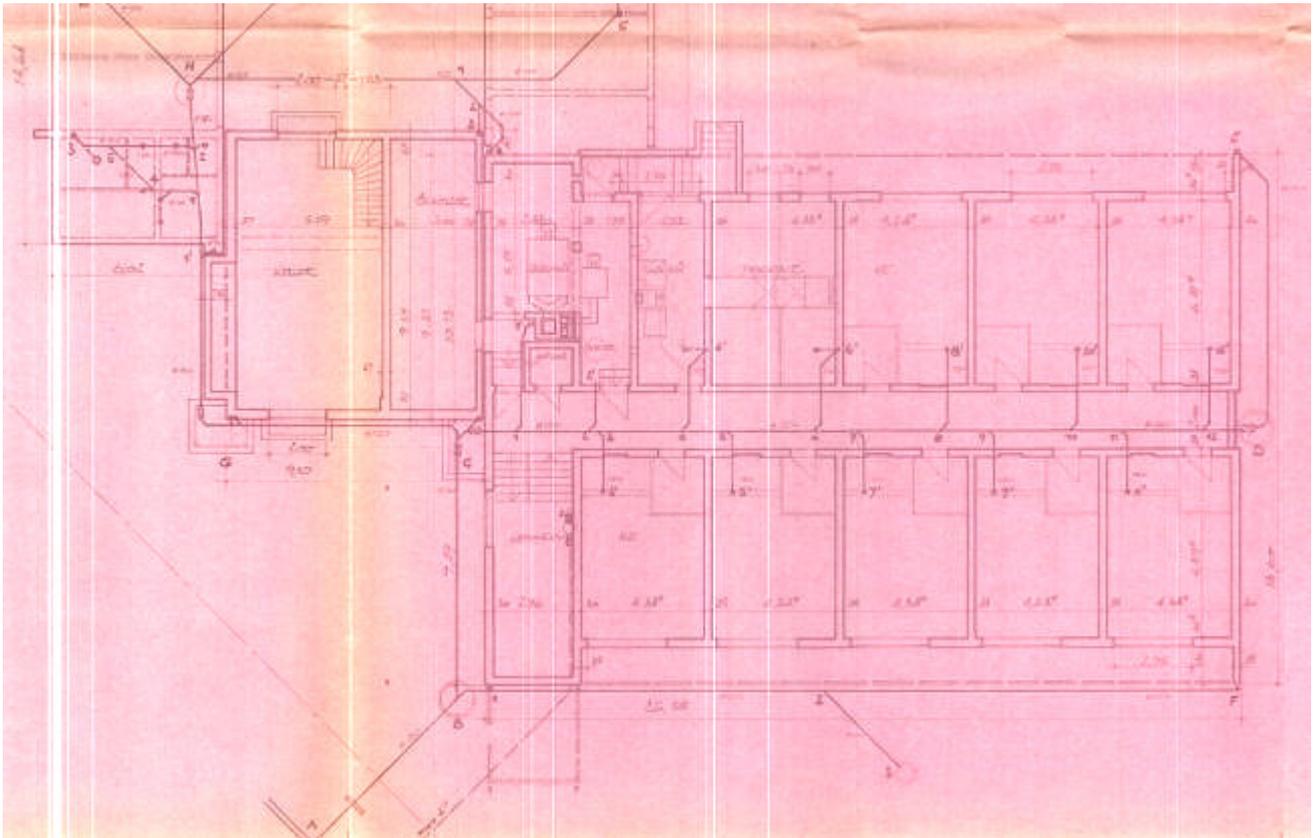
Grundriss Kellergeschoss; Quelle: Bauakte
